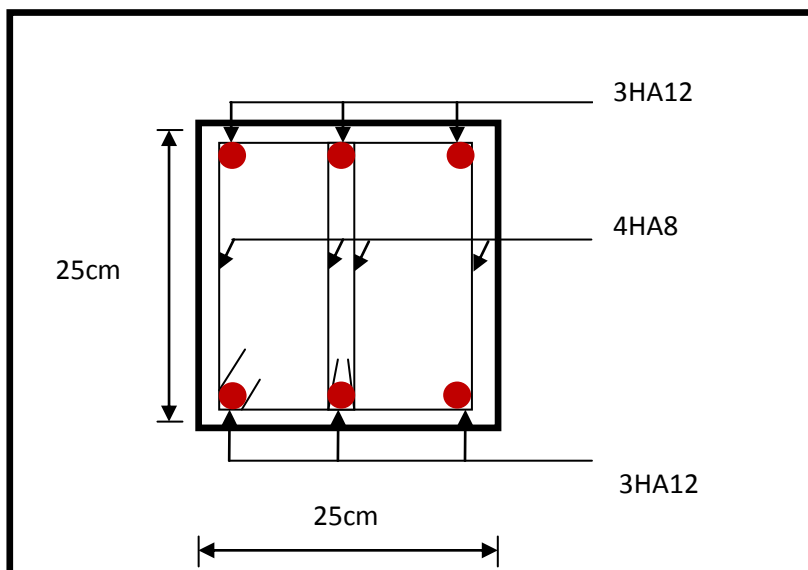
Ferrailage en appuis d'une poutre toiture.
